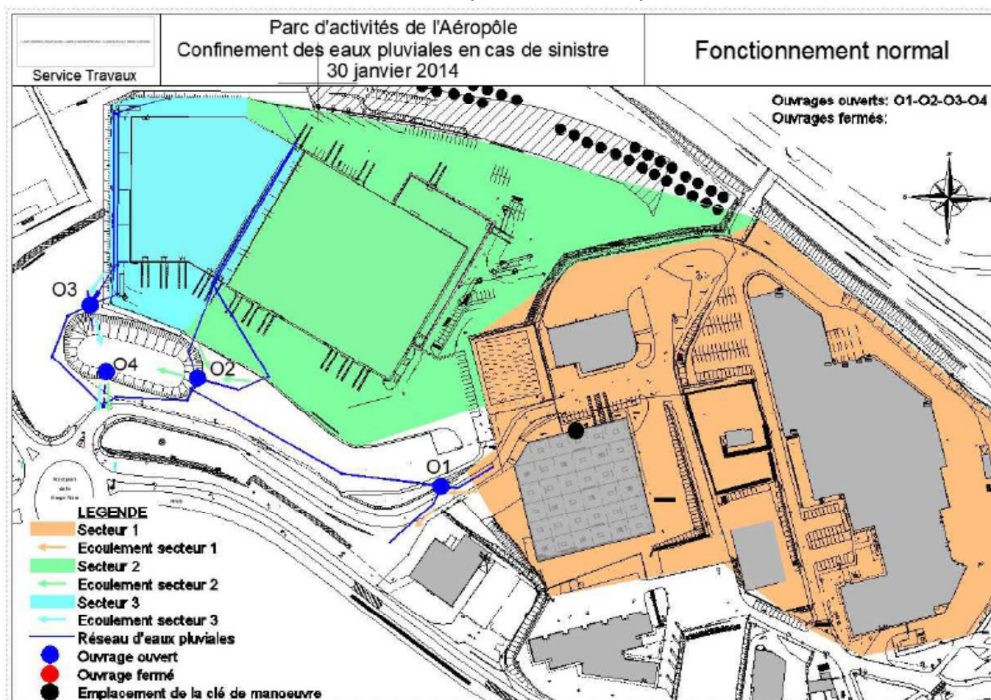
Plan de localisation des ouvrages pour confinement des eaux polluées (source : cabinet BOURGOIS)
